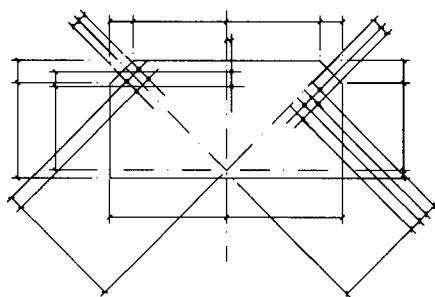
非焊接节点板尺寸的标注方法
